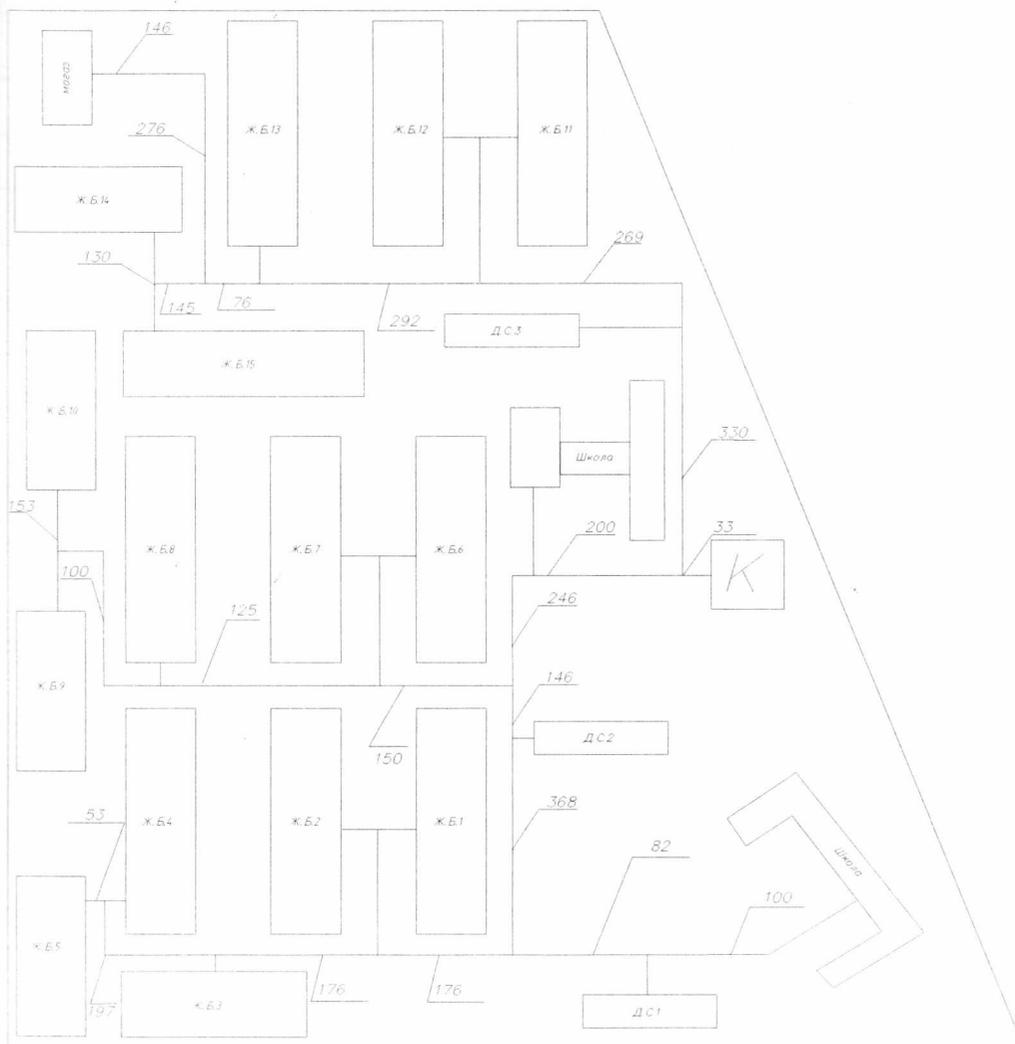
Монтажна схема теплової мережі відомої забудови
